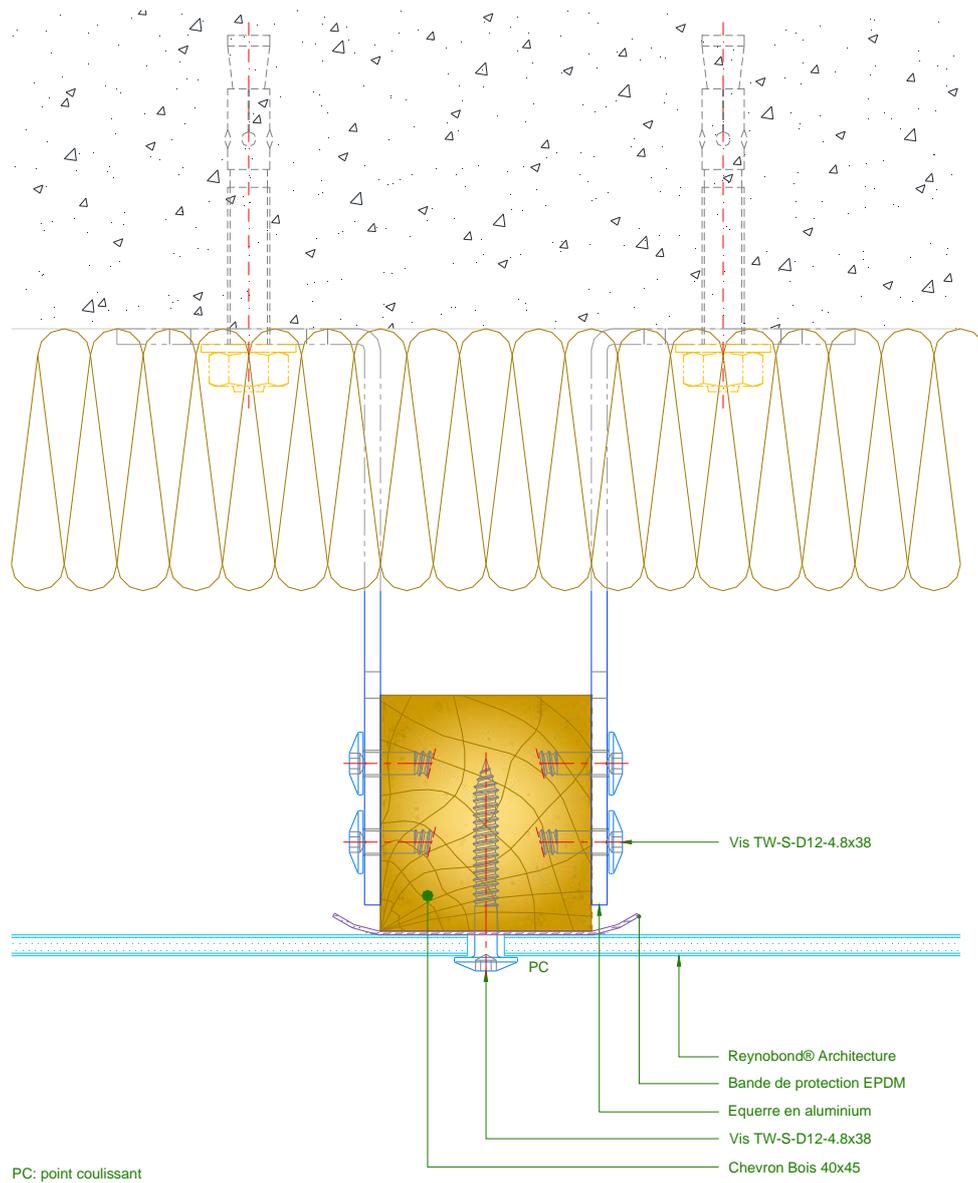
Joint horizontal – Système vissé SW 2c (coupe verticale)
